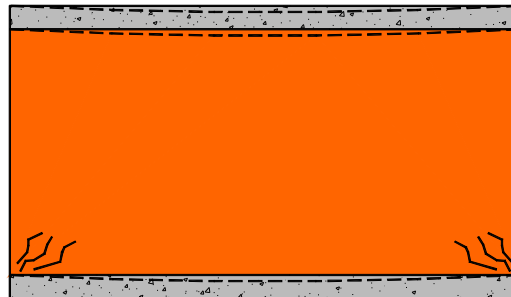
Fissuras em parede de vedação: deformação do suporte idêntica à deformação da viga superior [30]
